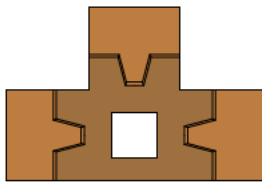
Konsole K-2 mit zwei Auflagefläche
